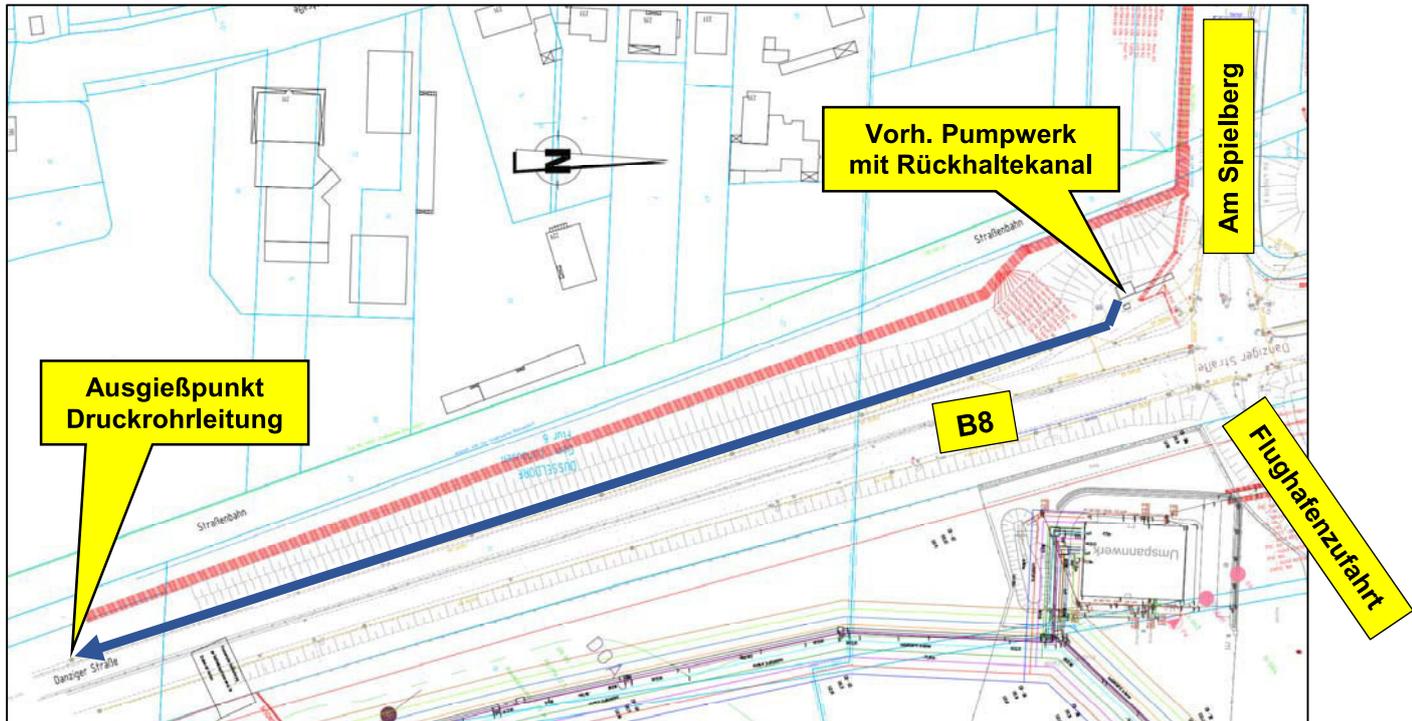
Lageplanausschnitt Bestand - Vorhandene Entwässerung
